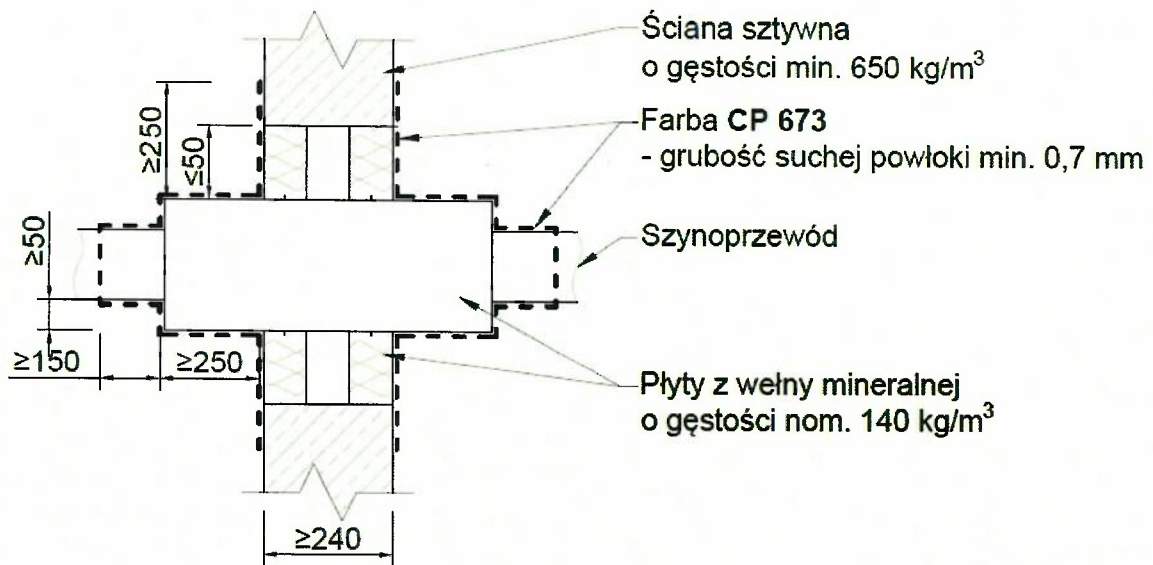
Przykład zabezpieczenia przejścia instalacyjnego w ścianie wykonanej z pustaków betonowych
